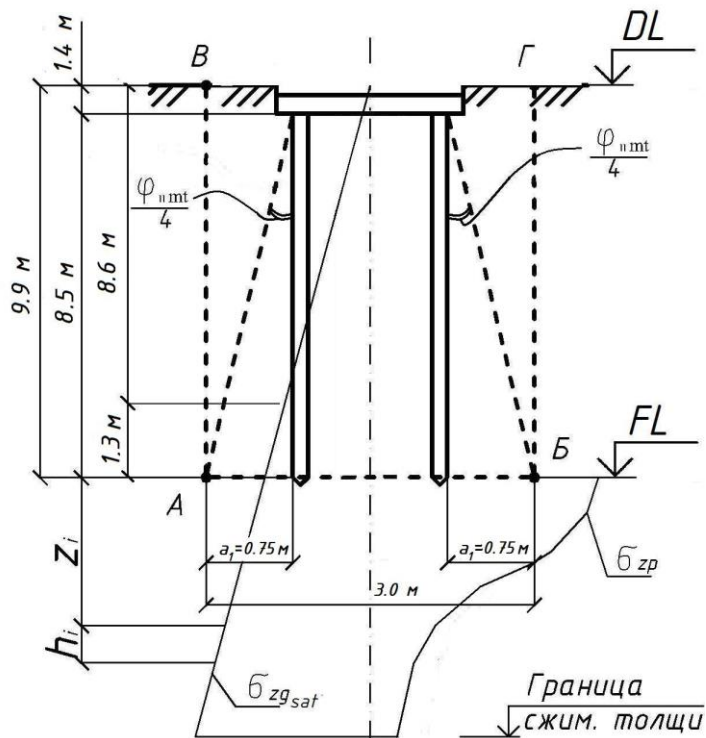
Определение границ условного фундамента при расчете осадок свайных фундаментов в грунтовых условиях I типа по просадочности:
